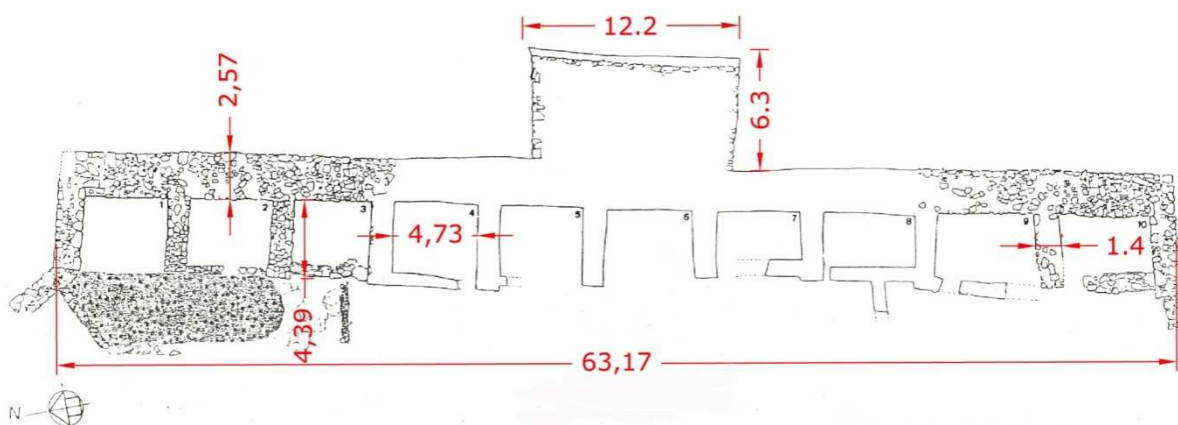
Planta del Casol de Puigcastellet amb indicació de les principals mesures en m recollides al text.
